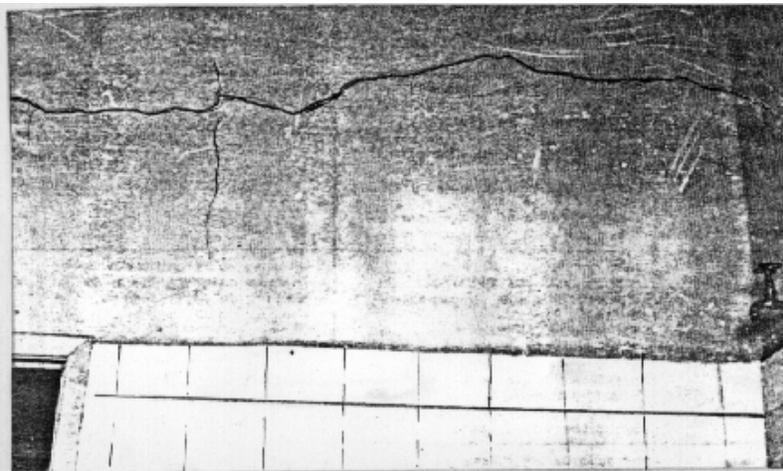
Aspecto do revestimento interno. Notam-se as fissuras do revestimento e da argamassa de rejuntamento dos azulejos.
